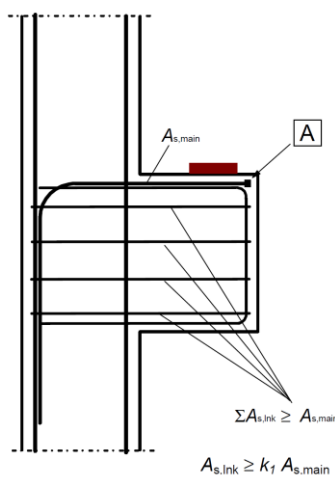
Pormenorização das armaduras de uma consola curta. Retirado de [14]
